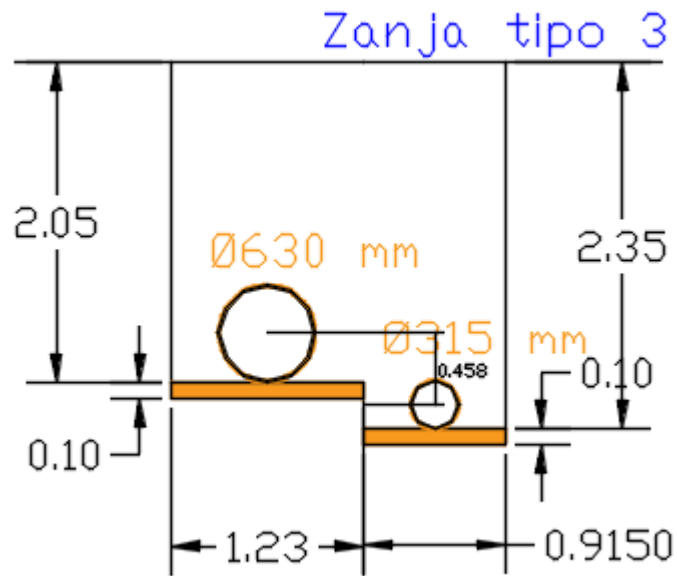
Zanja tipo 3 acotada. Fuente: Autocad.
